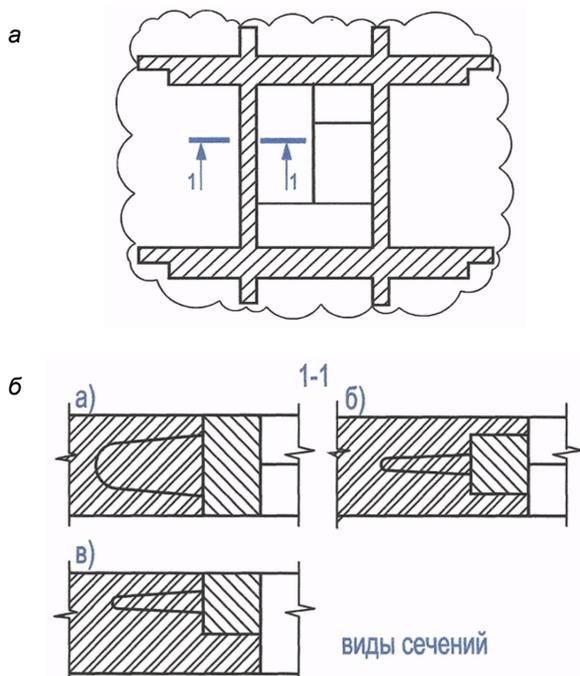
Фрагмент фасада здания, усиленного железобетонными сердечниками (а), и варианты поперечных сечений стен (б)
